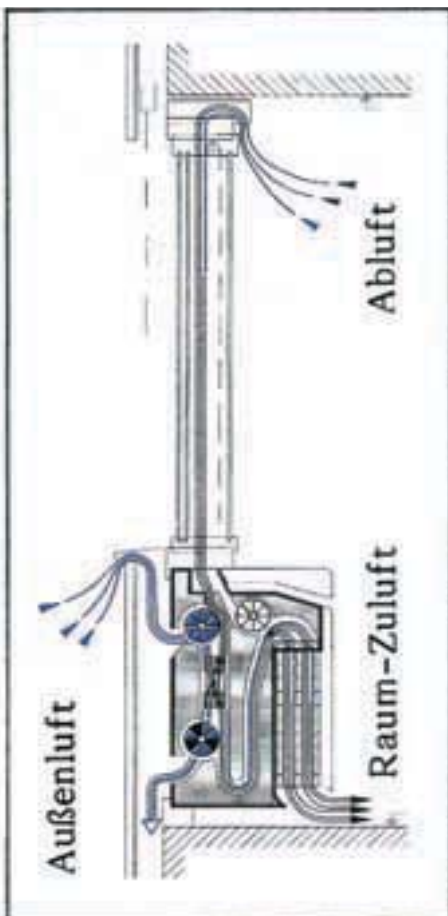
Schnitt durch eine Fassade mit Fassaden-Lüftungsgerät
